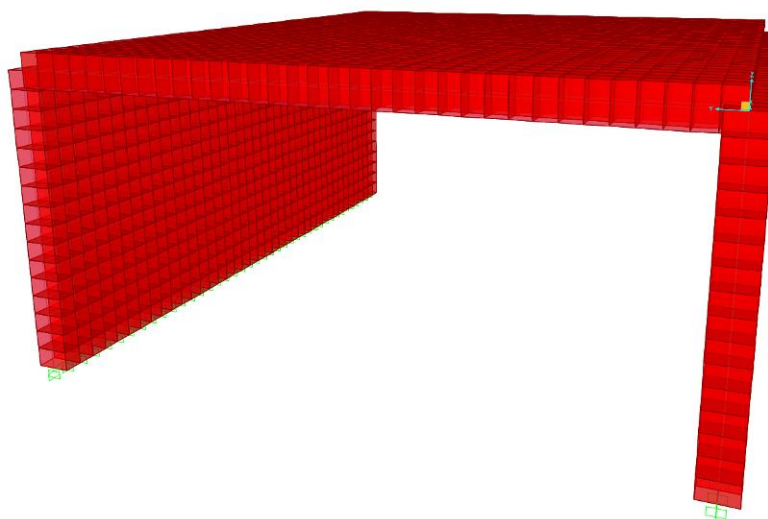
Vista 3D extruida del modelo de cálculo de la estructura E5
